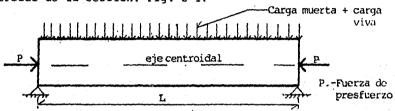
Viga de sección rectangular con una fuerza de presfuerzo aplicada concéntricamente y una carga aplicada trans versalmente.
